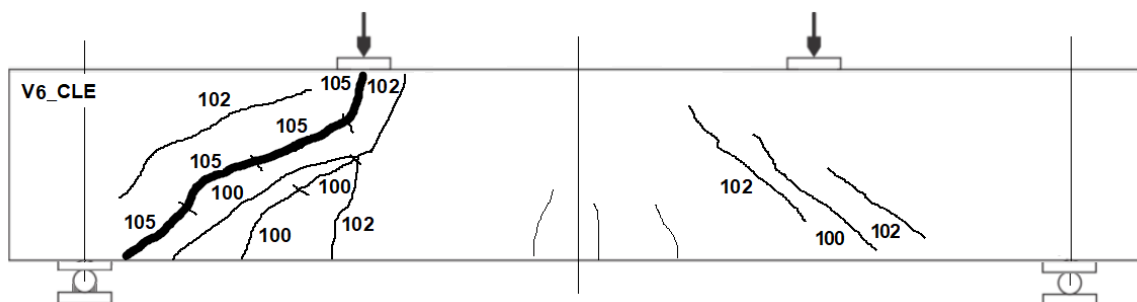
Esquema de fissuração da Viga 6_CLE.
